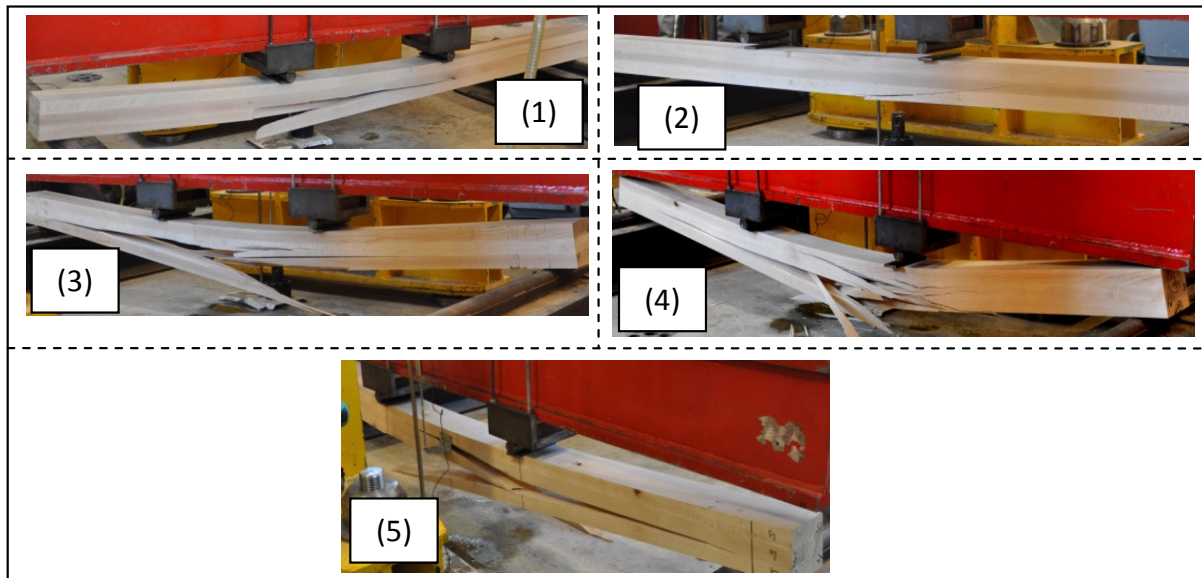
Modes de rupture en flexion à plat des poutres TRIO sans aboutage (type C).
